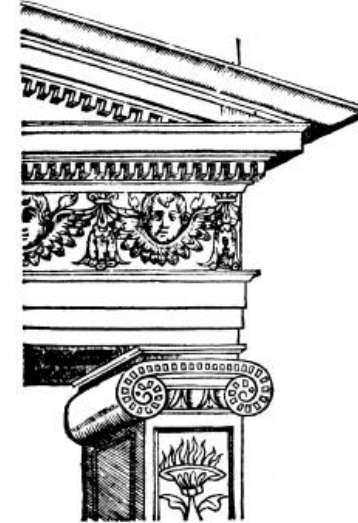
Detalles de la fachada retablo coincidentes con los tratados de Philibert de L'Orme y Sagredo.
